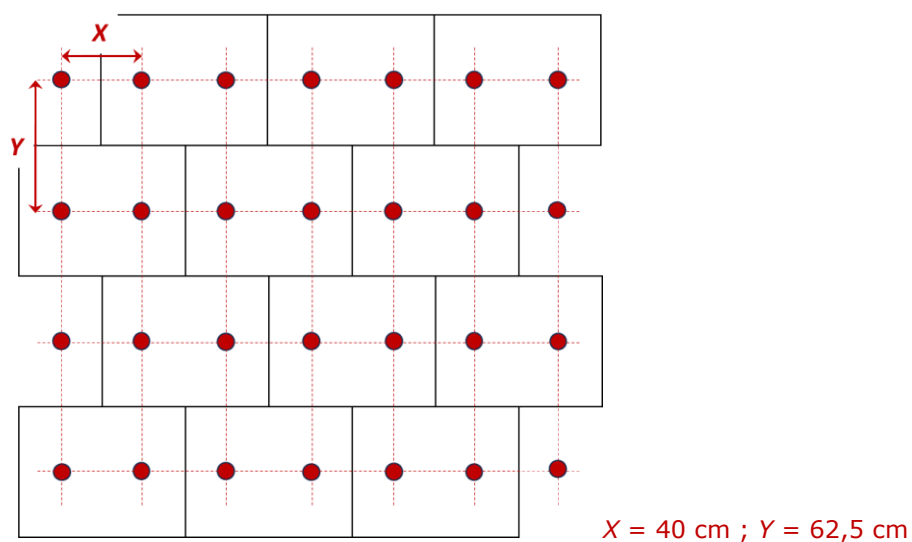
Plans de chevillage de panneaux de dimensions 800 x 625 mm – ECOROCK DUO PR uniquement
